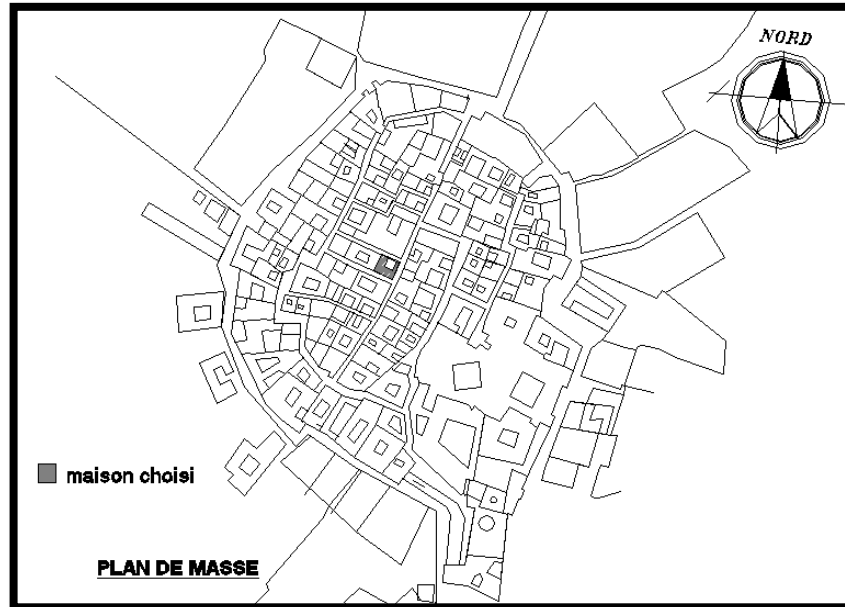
Plan de situation de maison a cour (2) .(Source : par l'auteur)
